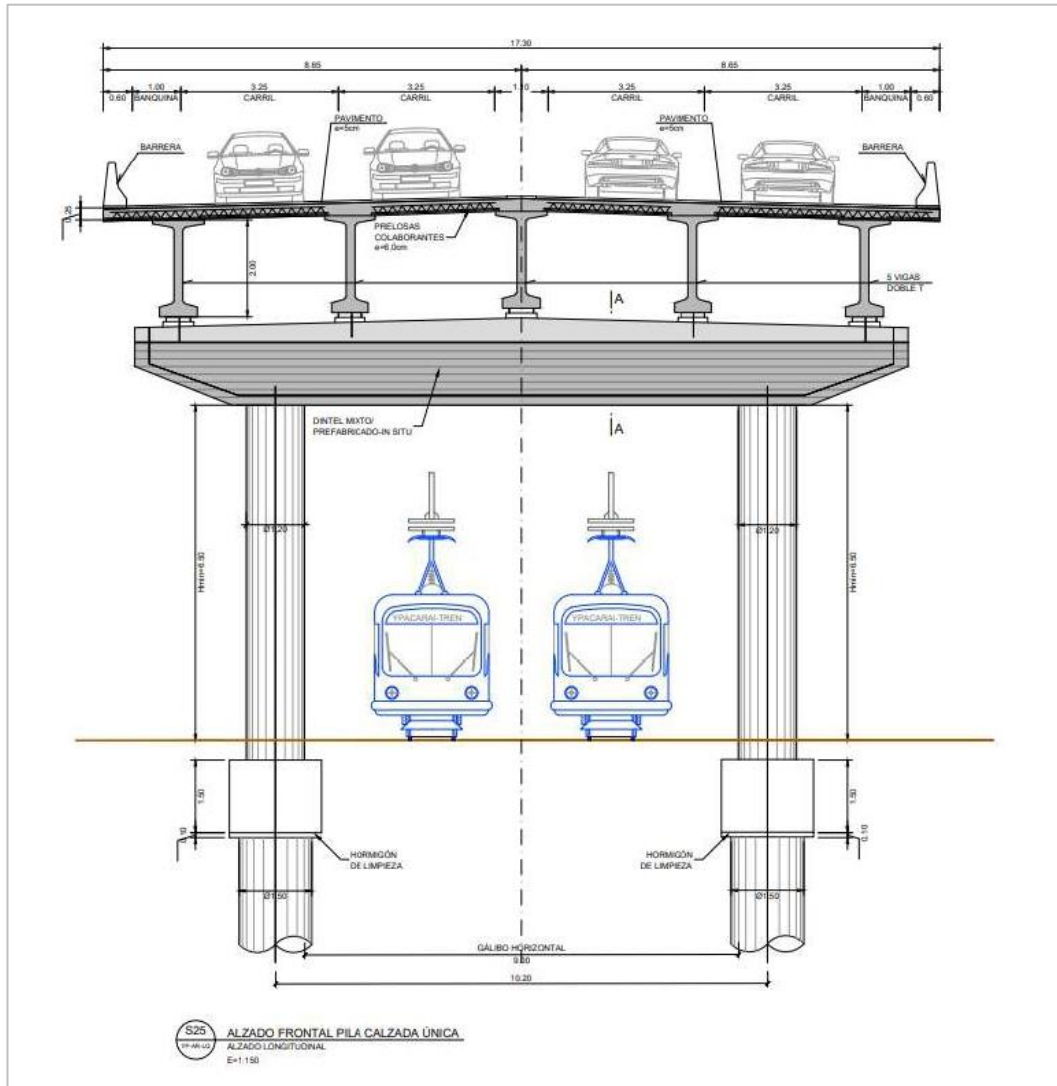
Sección tipo – Estructura (PK 27+115 al PK 30+449)
